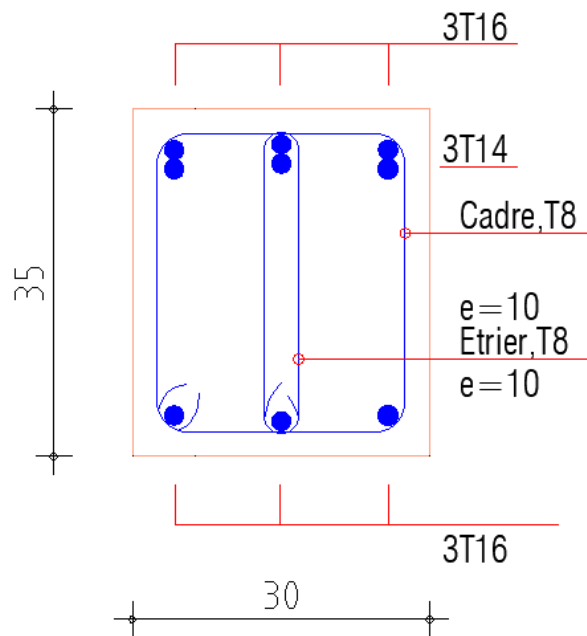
Ferrailage de poutre secondaire RDC → terrasse (appui).
